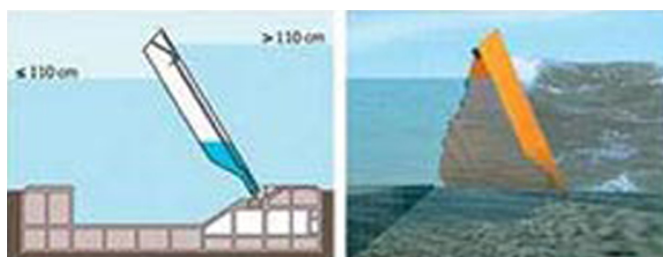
Rappresentazione del funzionamento del sistema di protezione FASE 3, paratoia sollevata
